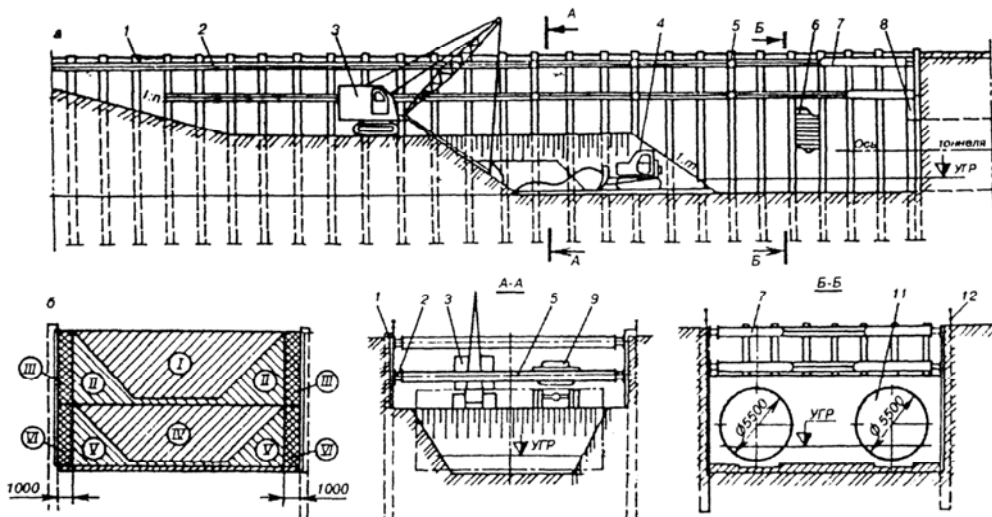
Схема розробки ґрунту при свайно-розпірному кріпленні котловану(а) та черговість розробки котловану (б):
